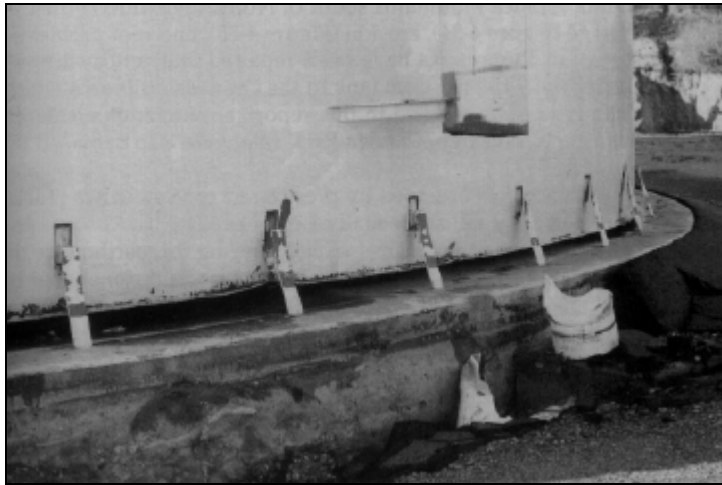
Falla de los anclajes por levantamiento en la base.
